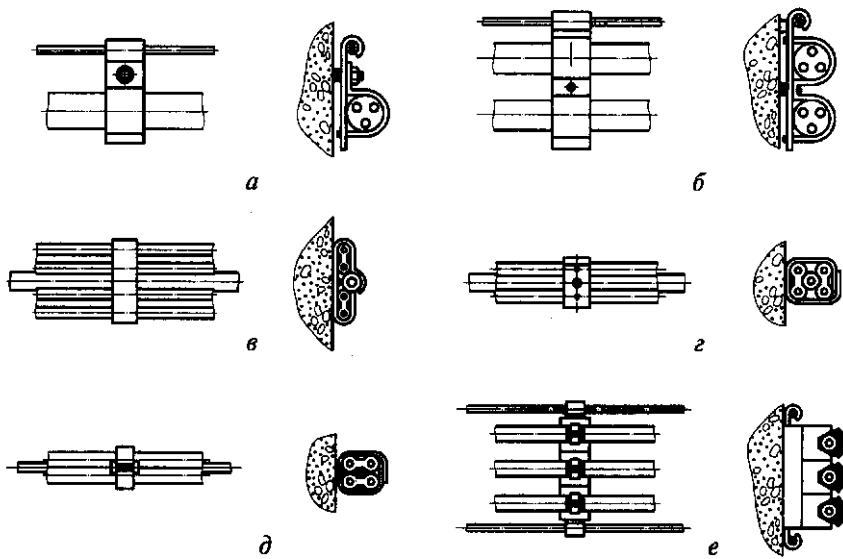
Прокладка кабеля и проводов по стенам с креплением к струнам:
